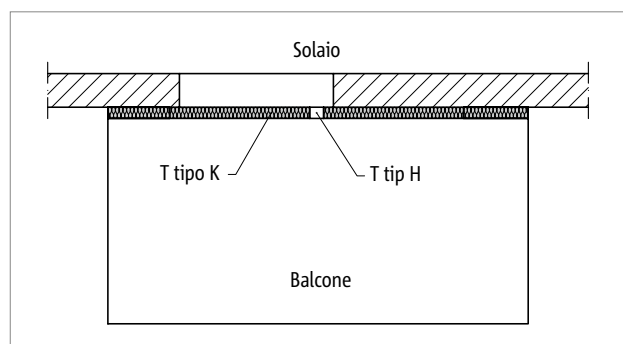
Schöck Isokorb® T tipo K: balcone a sbalzo; opzionale con T tipo H in presenza di carichi orizzontali di progetto, ad es. parapetti chiusi
